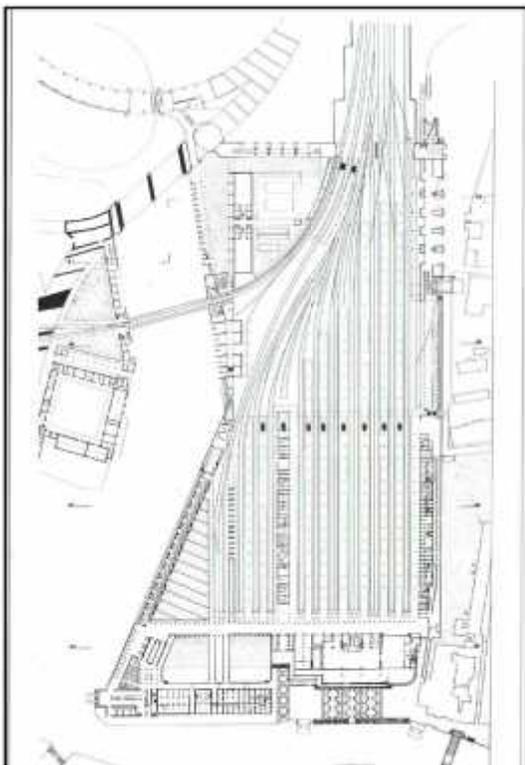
la zone de la station Ferrovière.plan du rez de chaussée. SrR.Bocchi
